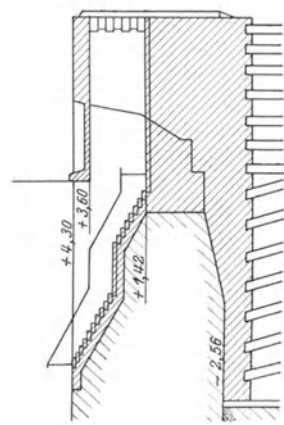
b. Bremer Ufermauer und Treppe. Schnitt. Maßstab 1 : 350.
